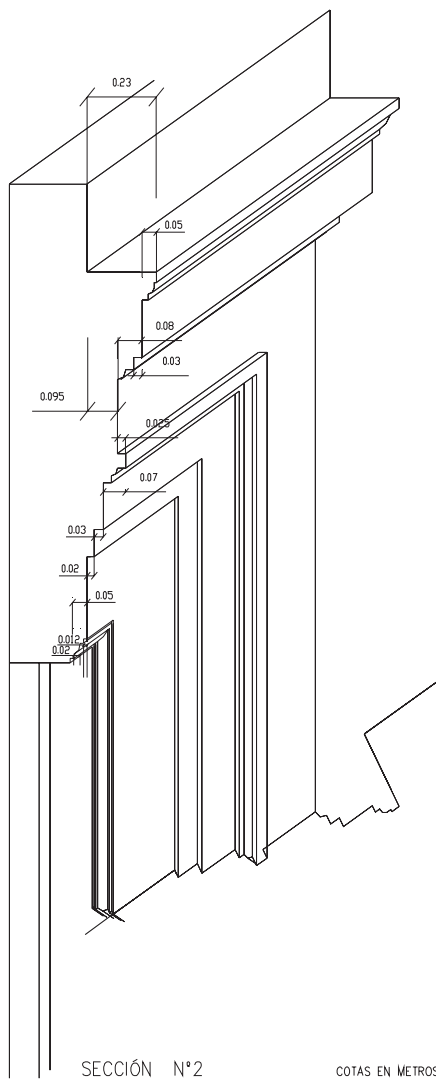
Plano de proyecto de la sección del dintel de la portada de la fachada norte.
